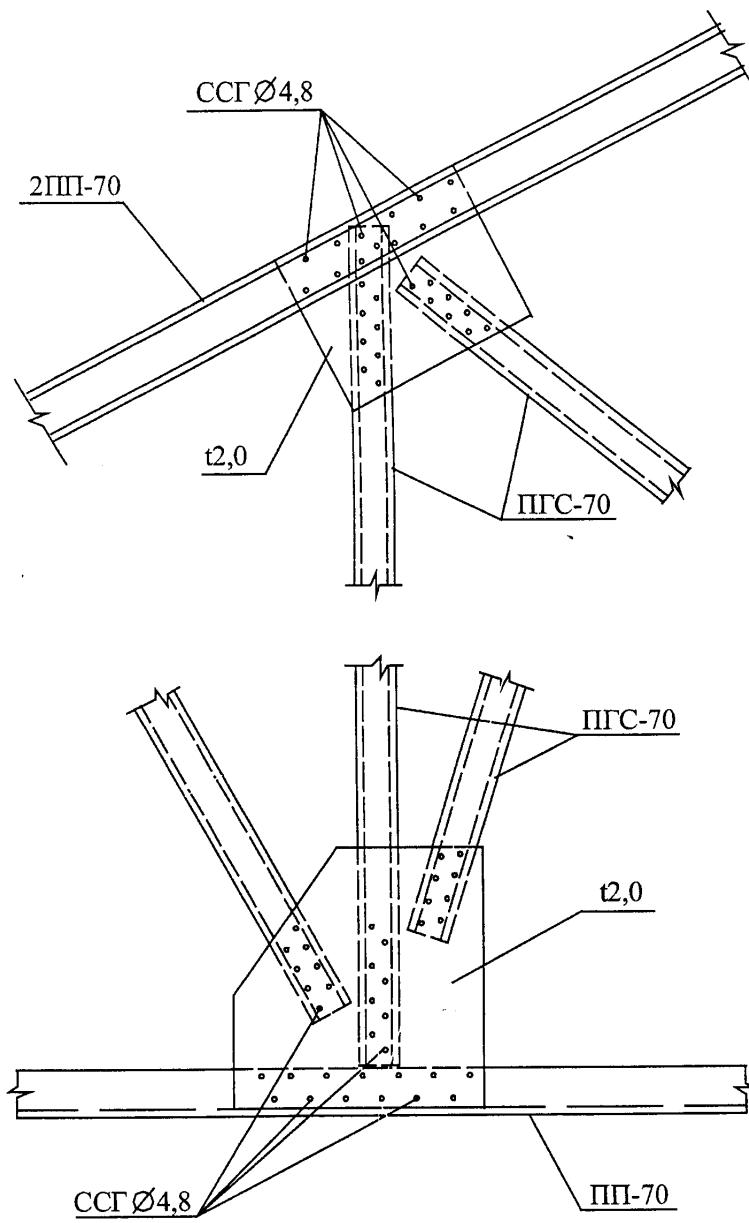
Вузли верхнього та нижнього поясів ферми
